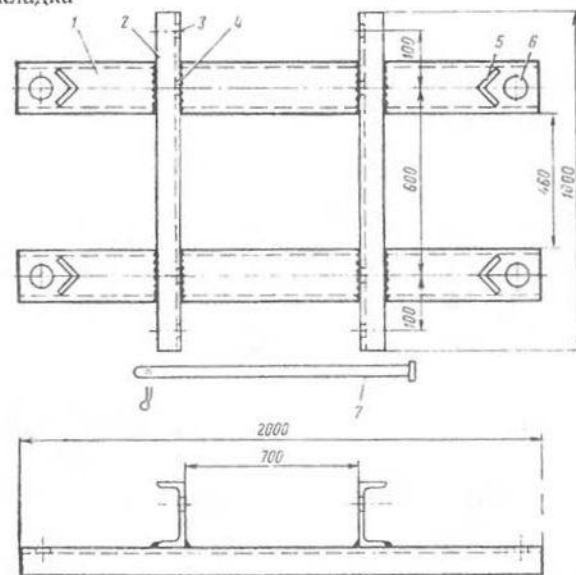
Конструкция "фундамента" с креплением за грунт:
